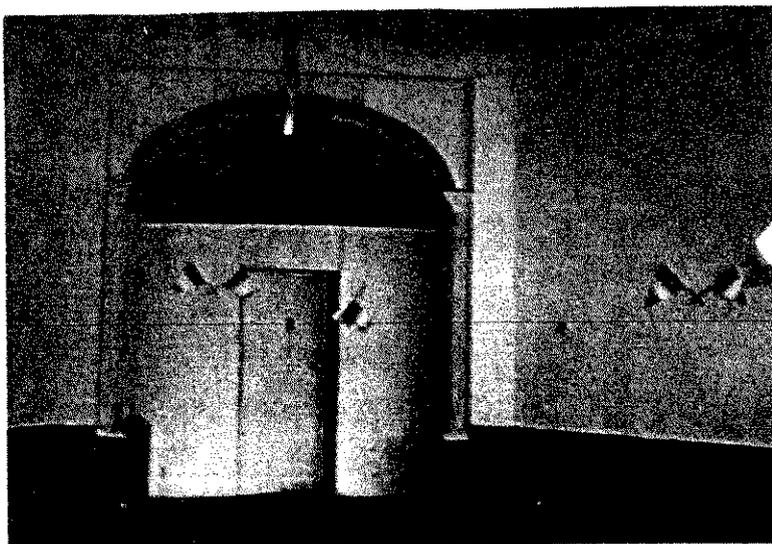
Detalle interior de puerta principal de la esquina de la 12 av.
